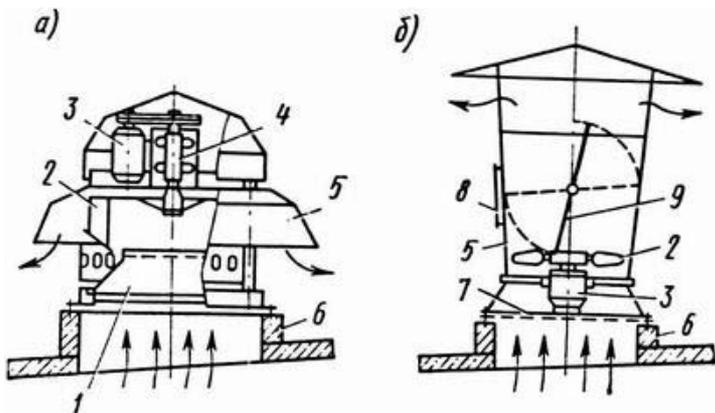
Крышные вентиляторы: а - радиальный ВКР-4; б - осевого ЦЗ-04:
